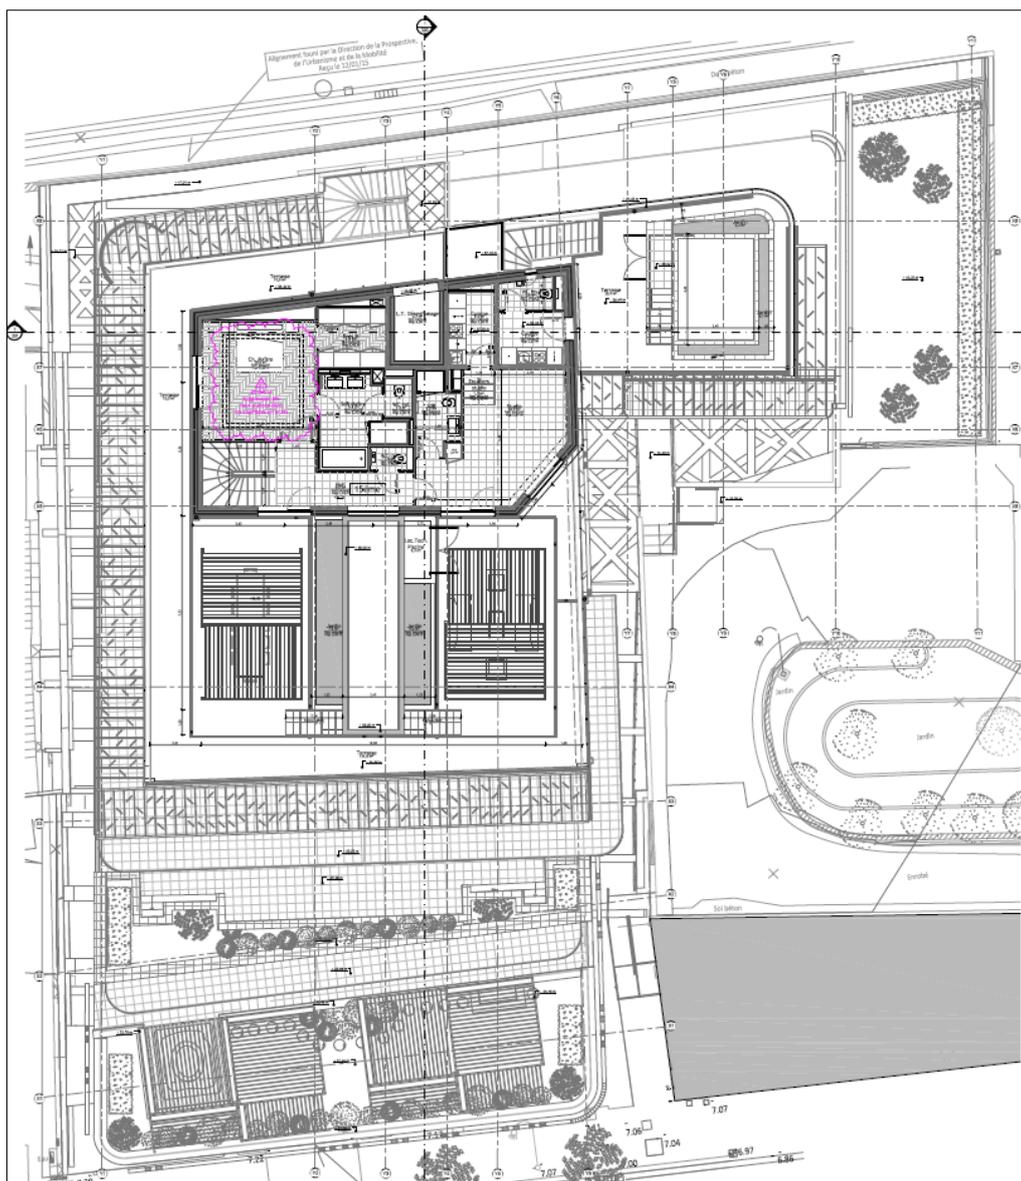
Pianta architettonica, quindicesimo piano (R+15 duplex)
